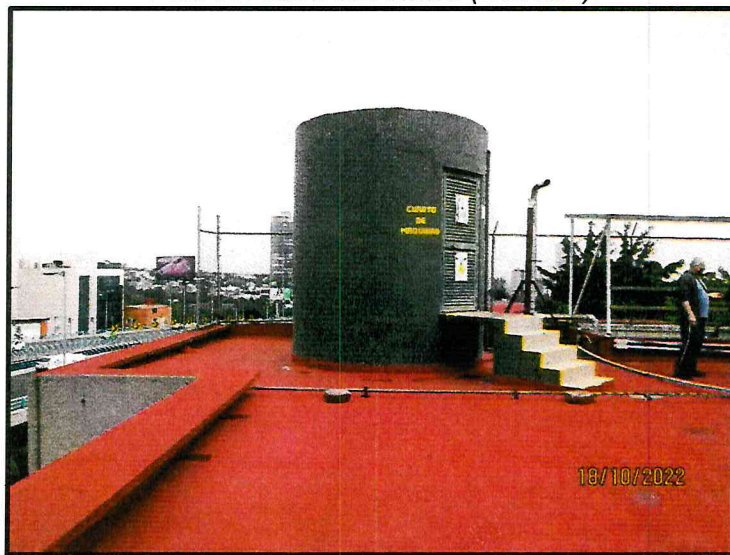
Zona de Azotea (Cuarto de máquinas de elevador).
